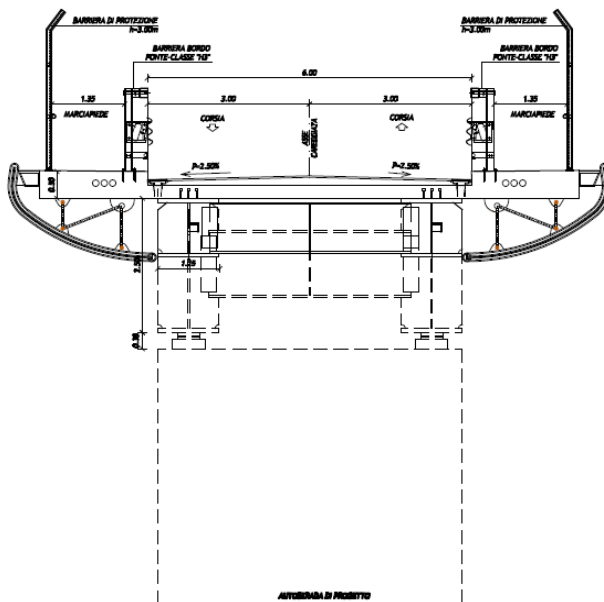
SEZIONE TIPO IMPALCATO CAVALCAVIA DI STRADA PODERALE
